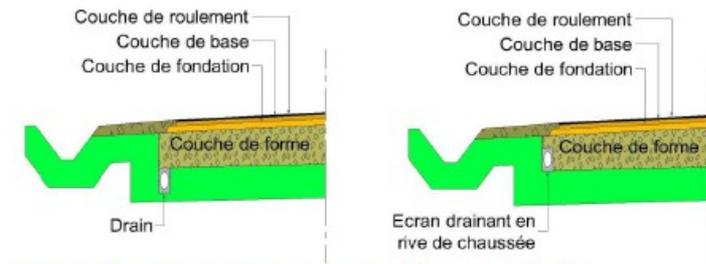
dispositifs de drainage, pour une plate-forme encaissée
